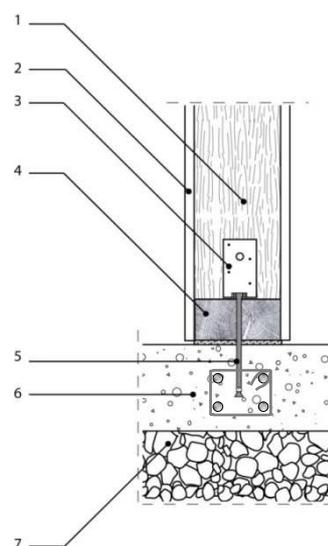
Schémas de principe d'un panneau courant de refend (coupe verticale).
